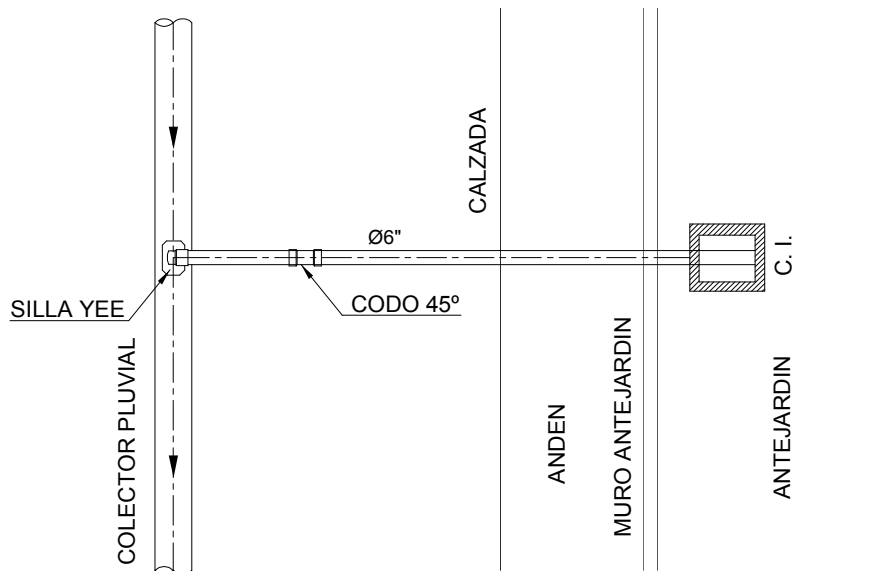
Alineación horizontal para Acometidas en Pavimento Rígido.
